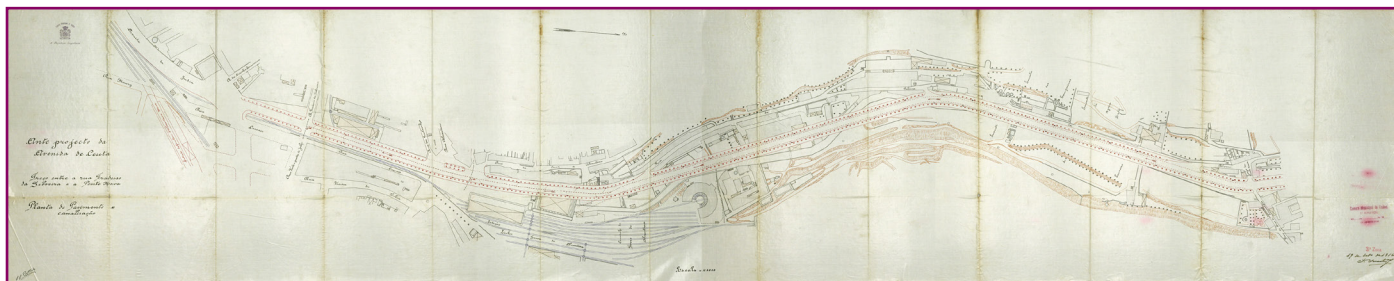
AML, Planta de Pavimentação e canalização do troço entre a Rua Fradesso da Silveira e a Ponte Nova, incluída no Projeto da Avenida de Ceuta.
